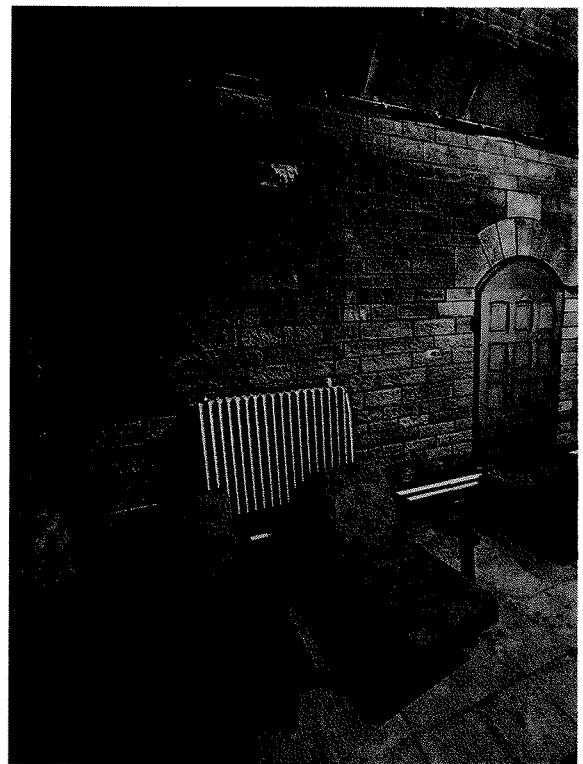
Umiditate excesivă pereti subsol-trapeză
